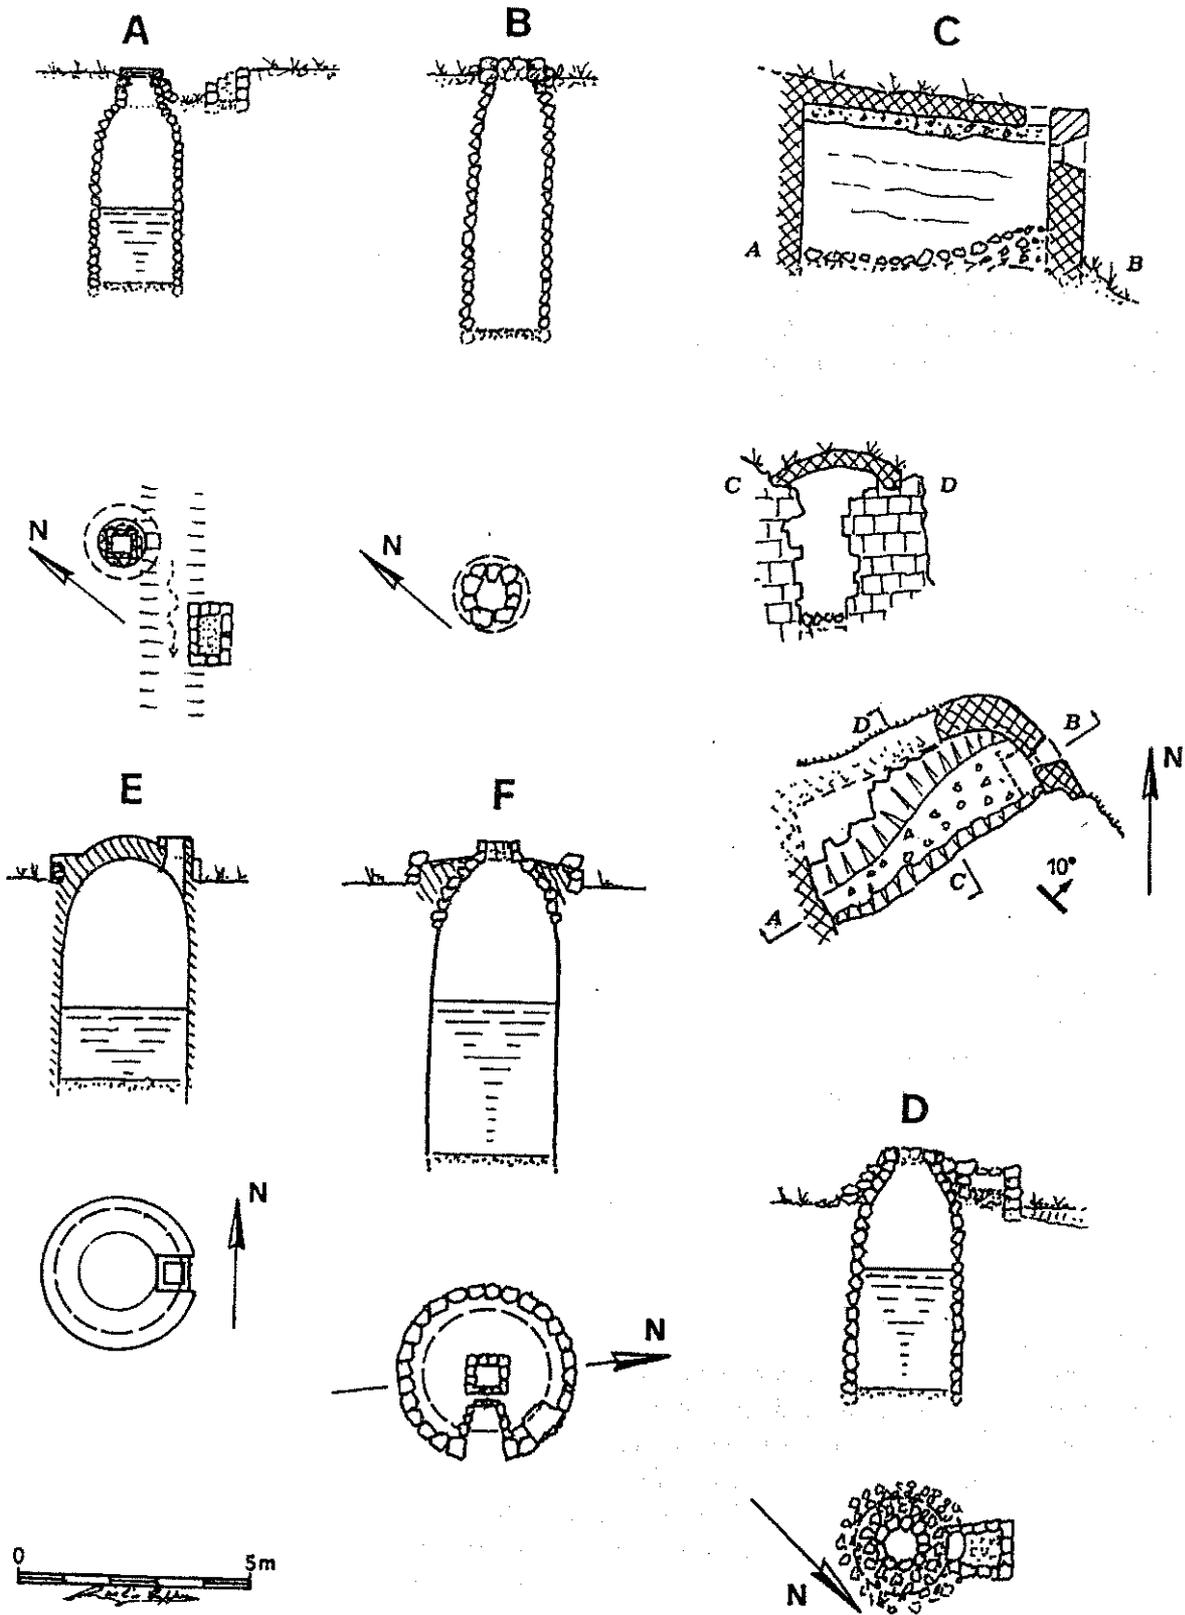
Pianta e sezione delle cisterne A, B, C, D, E, F di Fig. 2.
